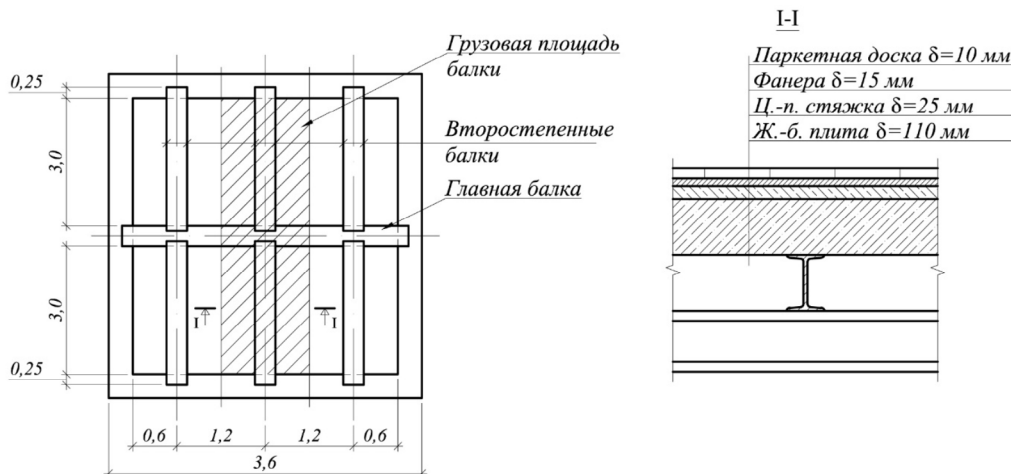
Сбор нагрузок на 1 м^2 перекрытия
